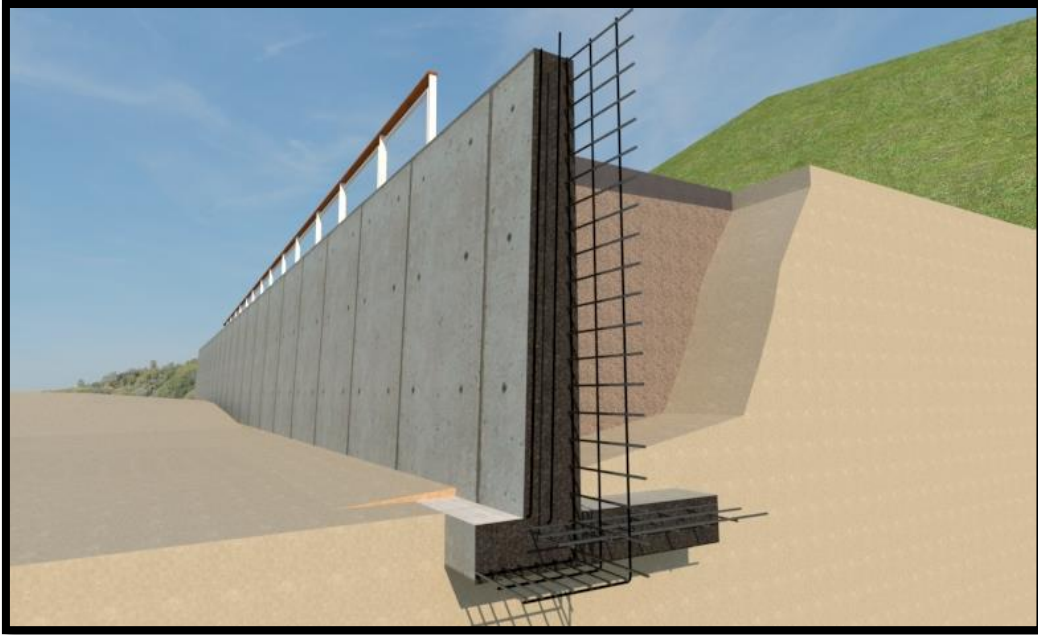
Disposición de armaduras del muro de sostenimiento (fuente: elaboración propia).
